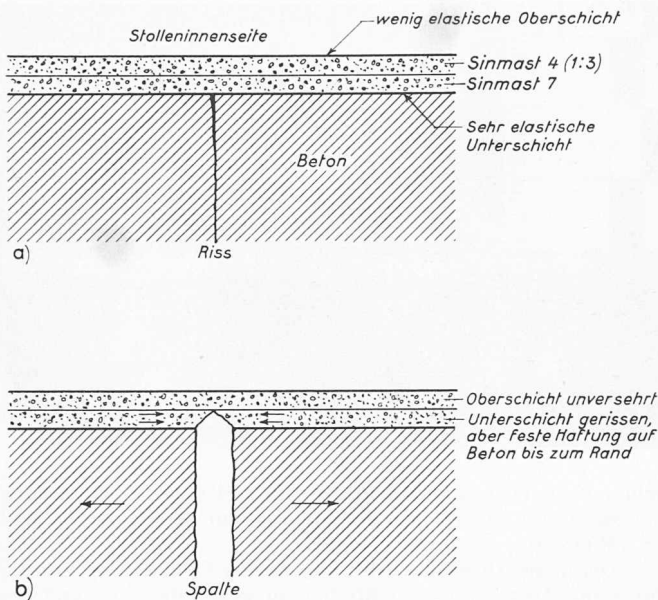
Verhalten des doppelschichtigen Buton-Epikotes über dem sich erweiternden Riss im Beton
